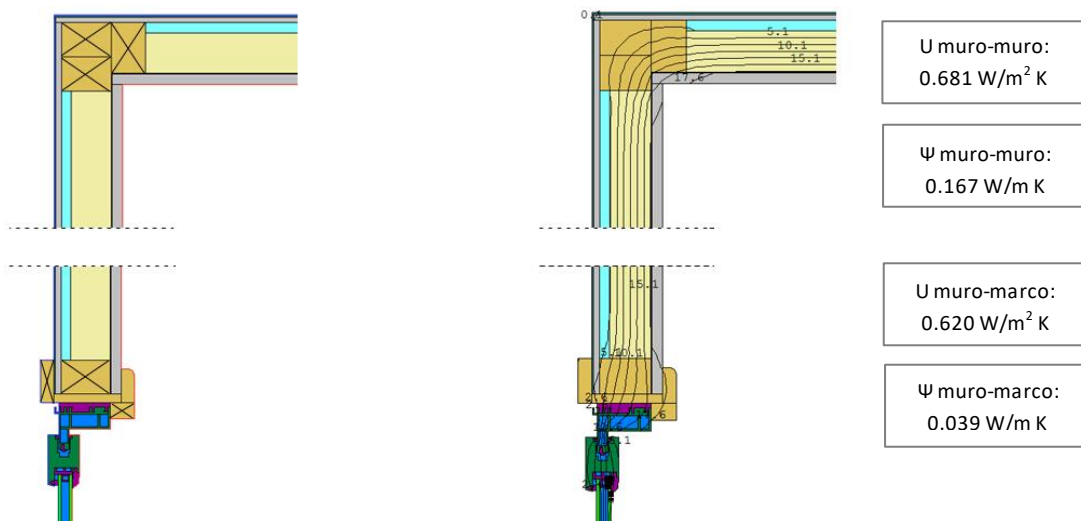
Detalle y diagrama de unión de esquina y unión muro-marco en vista de planta, muro base
